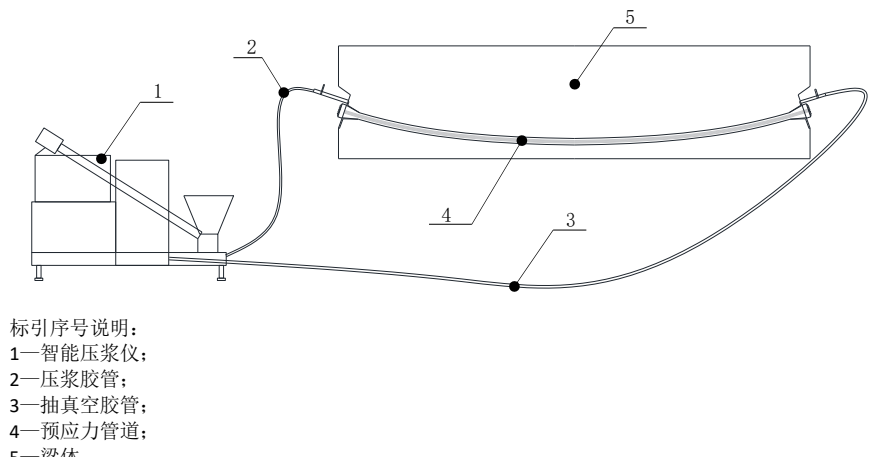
预应力混凝土预制梁智能压浆设备连接示意图
